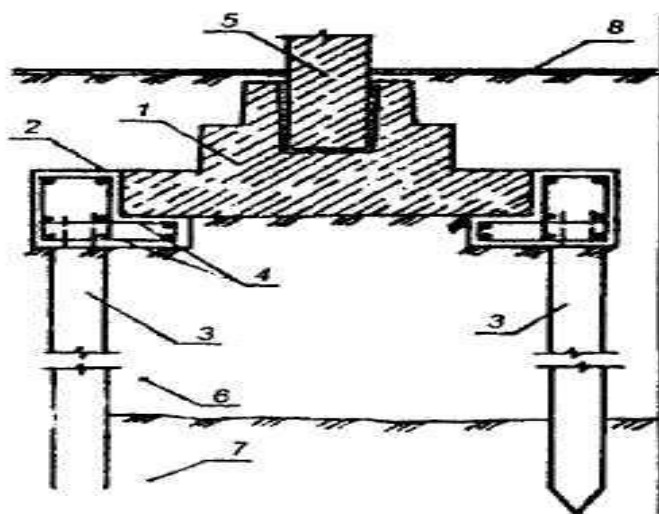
Передача нагрузки от фундамента на железобетонные сваи, погружаемые вдавливанием
